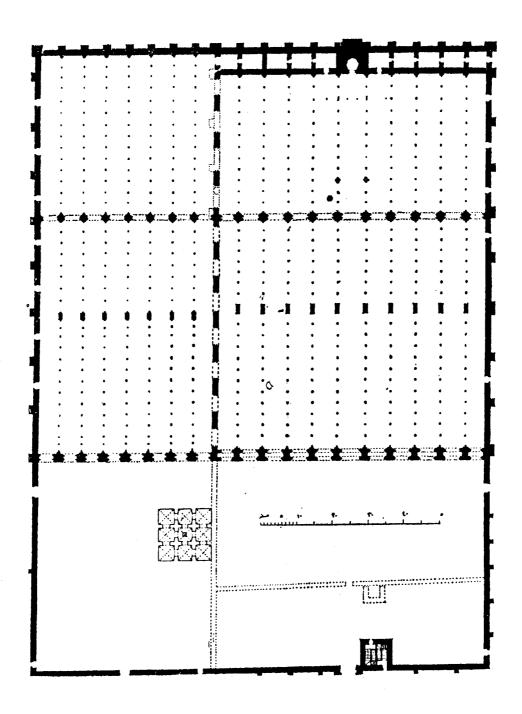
مسقط أفقي لجامع القيروان بتونس (عن : Lezine) .
